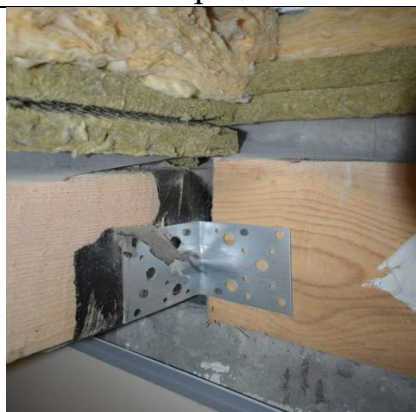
Межэтажное перекрытие на отм. +8,910 (вид1)
